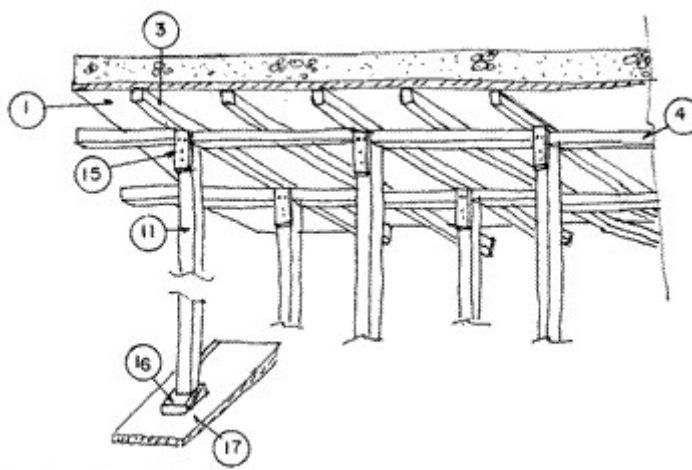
Sistema de montagem de fôrmas para laje [Fonte: Blog Construção Civil Tips 2012].
